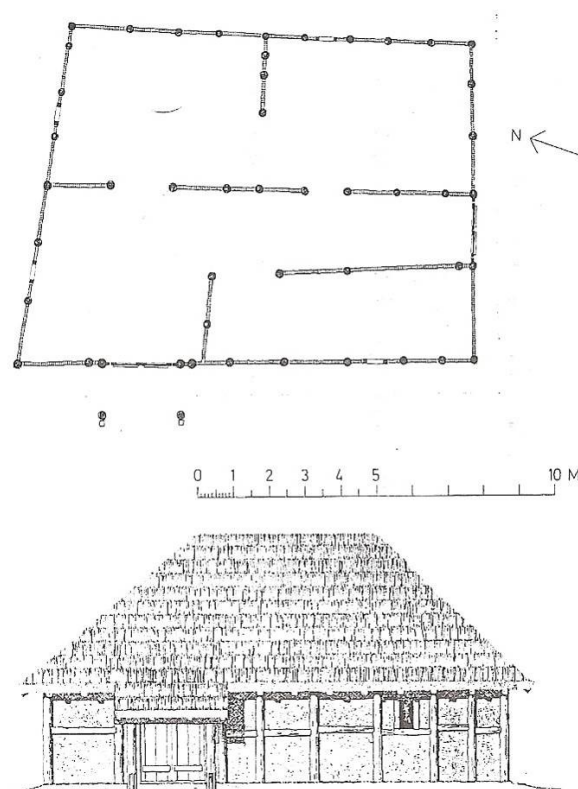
Planimetria e ricostruzione degli elevati della casa di Laufon-Muschag (PAUNIER 1985, p. 123)
